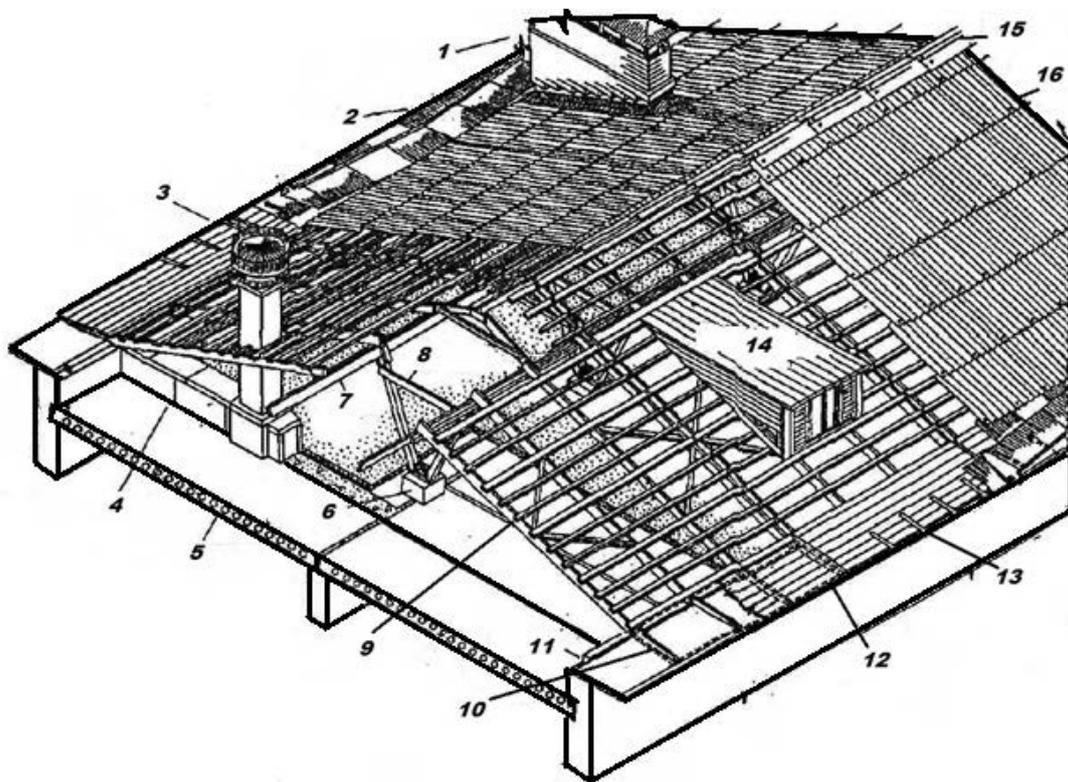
Чердачная крыша с кровлей из волнистых асбестоцементных листов при продольных несущих стенах: 1 — дымовентиляционный стояк; 2 — карнизный обвес и настенный желоб, выполненные из оцинкованной кровельной стали; 3 — дефлектор для усиления тяги, утепленная шахта из дощатых щитов, обшитых кровельной сталью по вымоченному в глине войлоку (площадь сечения по расчету); 4 — короб из гипсошлаковых плит, объединяющий вытяжные каналы; 5 — чердачное перекрытие из ж/б плит, утепленное минеральной ватой; 6 — ж/б блок $400 \times 400 \times 300$ со стальным башмаком из уголка 120×10 ; 7 — неразрезной прогон из двух досок; 8 — опорный треугольник из подкосов; 9 — стропильный щит верхний, состоящий из ферм и обрешетки, опирающийся на прогоны и прибитый к стропилам нижнего щита; 10 — стропильный щит нижний, состоящий из стропил и обрешетки, опирающийся на мауэрлат и прогон; 11 — мауэрлат, площадь сечения 100×100 ; 12 — карнизный щит, состоящий из кобылок и опалубки, положенный на карнизную плиту и прибитый к стропилам нижнего щита; 13 — Т-образные костыли для карнизного свеса и крюки настенного желоба, прибитые к опалубке через 600 мм; 14 — короб слухового окна, обшитый кровельной сталью; 15 — коньковый полуволнистый шаблон; 16 — рядовой волнистый шаблон
